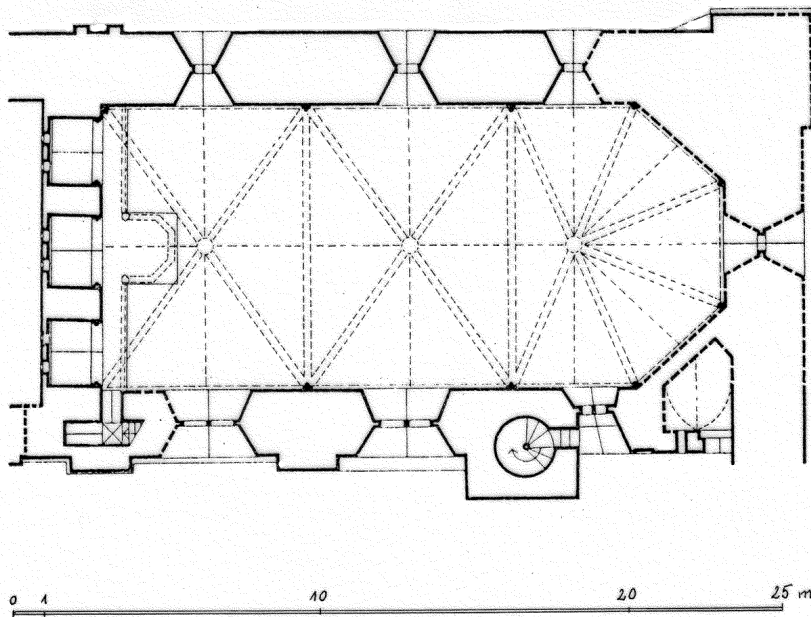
Marienburg/Malbork. Hauptgeschoß, Grundriß der ersten Konventskirche. Schnitt auf der Fenster-ebene. Nach M. Kilarski.
